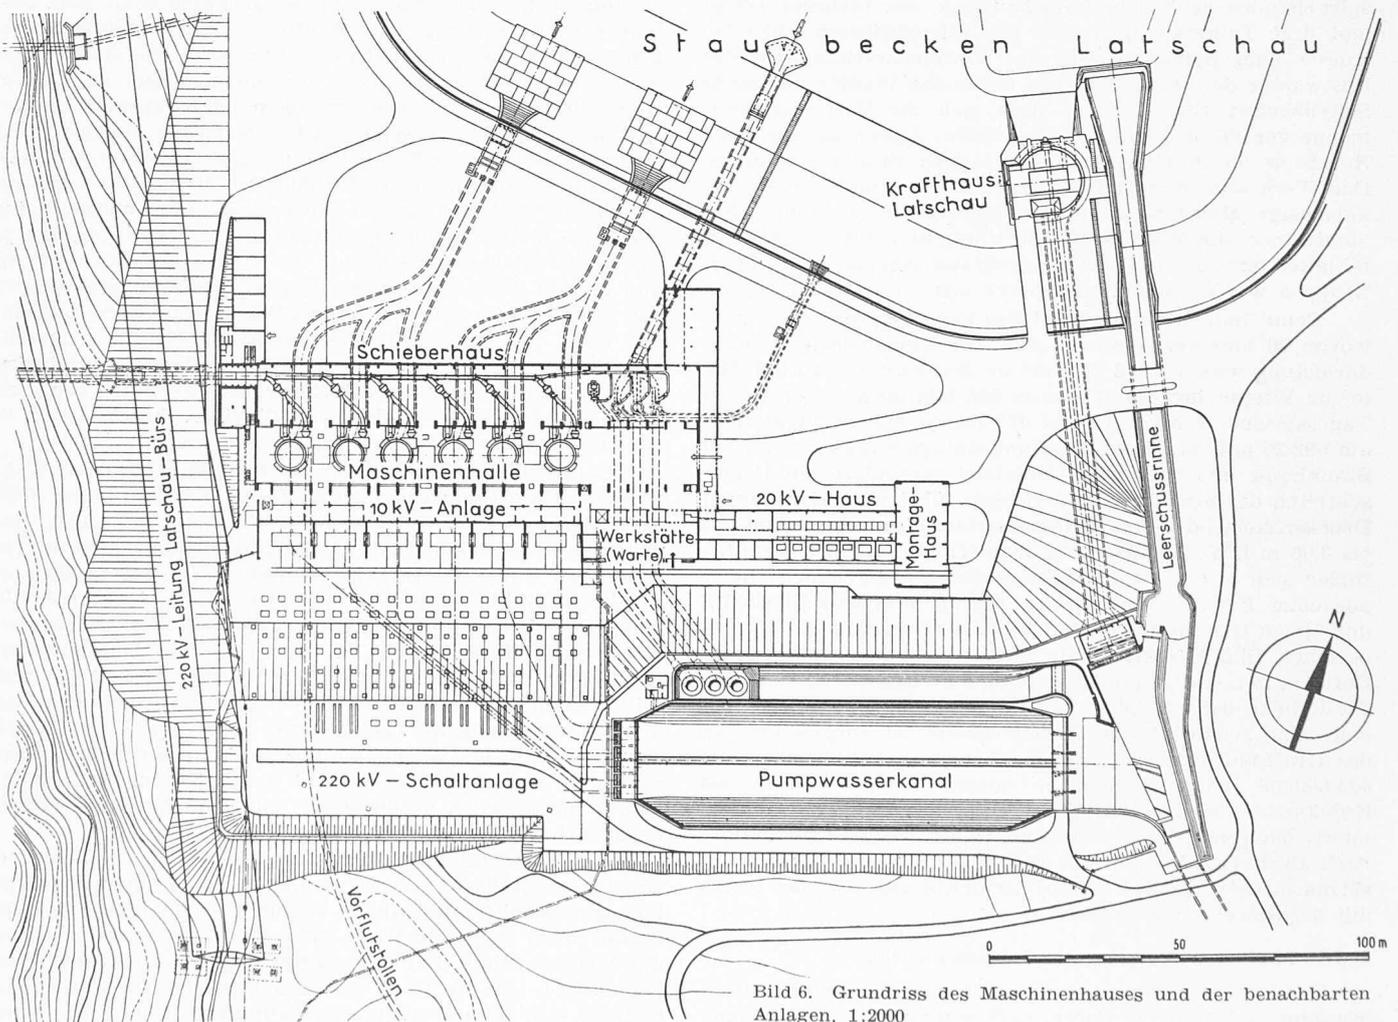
Grundriss des Maschinenhauses und der benachbarten Anlagen, 1:2000
